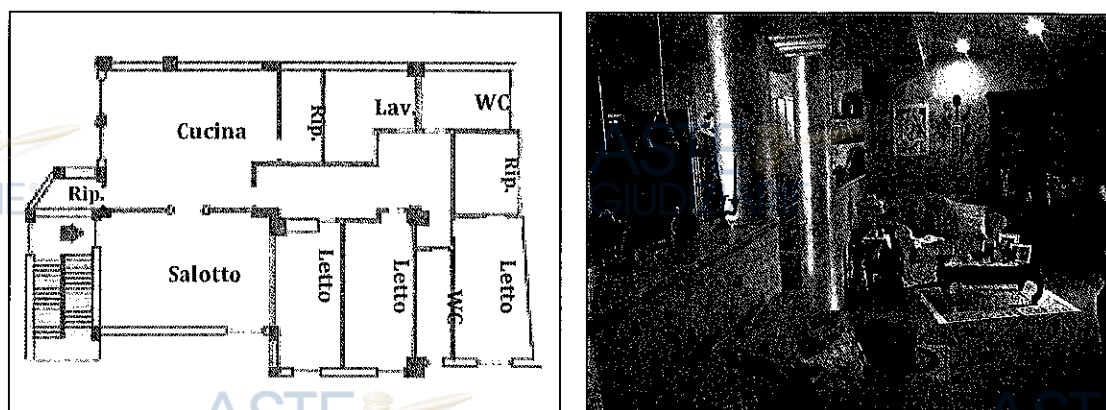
planimetria e immagine ripresa dall'ingresso dell'appartamento (f.83, p.228, sub 30).
